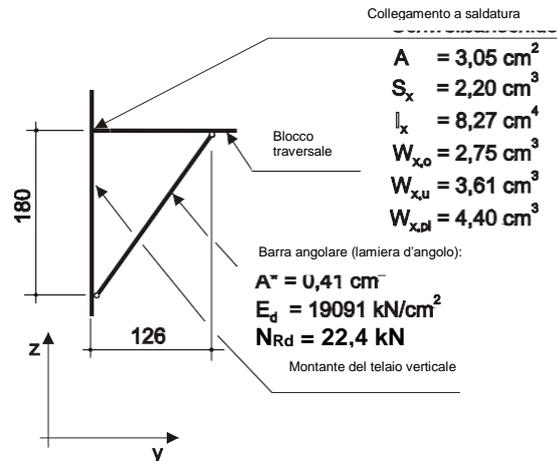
Valori caratteristici per il collegamento del blocco traversale e montante del telaio verticale del telaio di supporto con il fazzoletto LW
